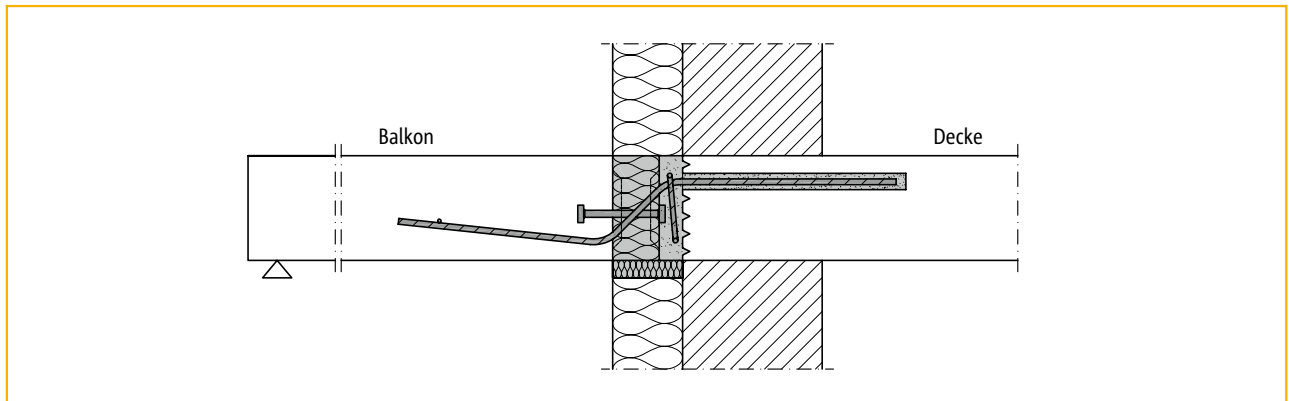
Mauerwerk mit Aussendämmung bei Stützenlagerung und Typ RQP
